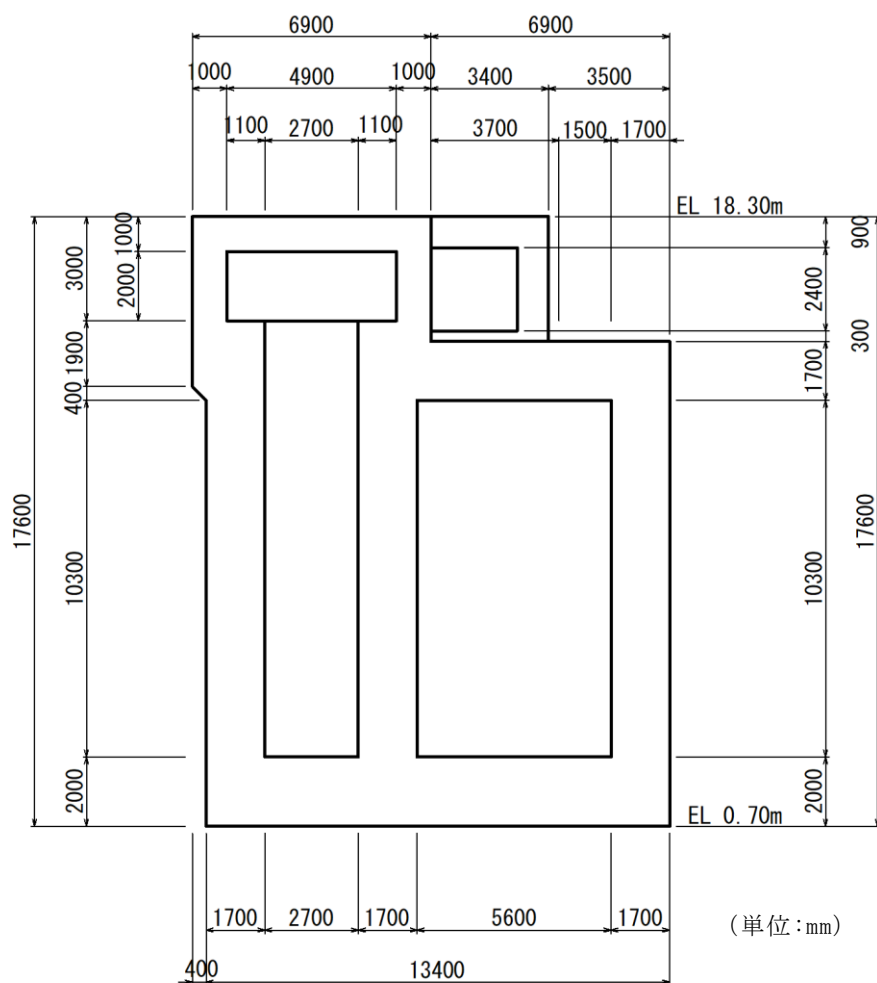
(5) 第1 ベントフィルタ格納槽 断面図 (E-E断面)
